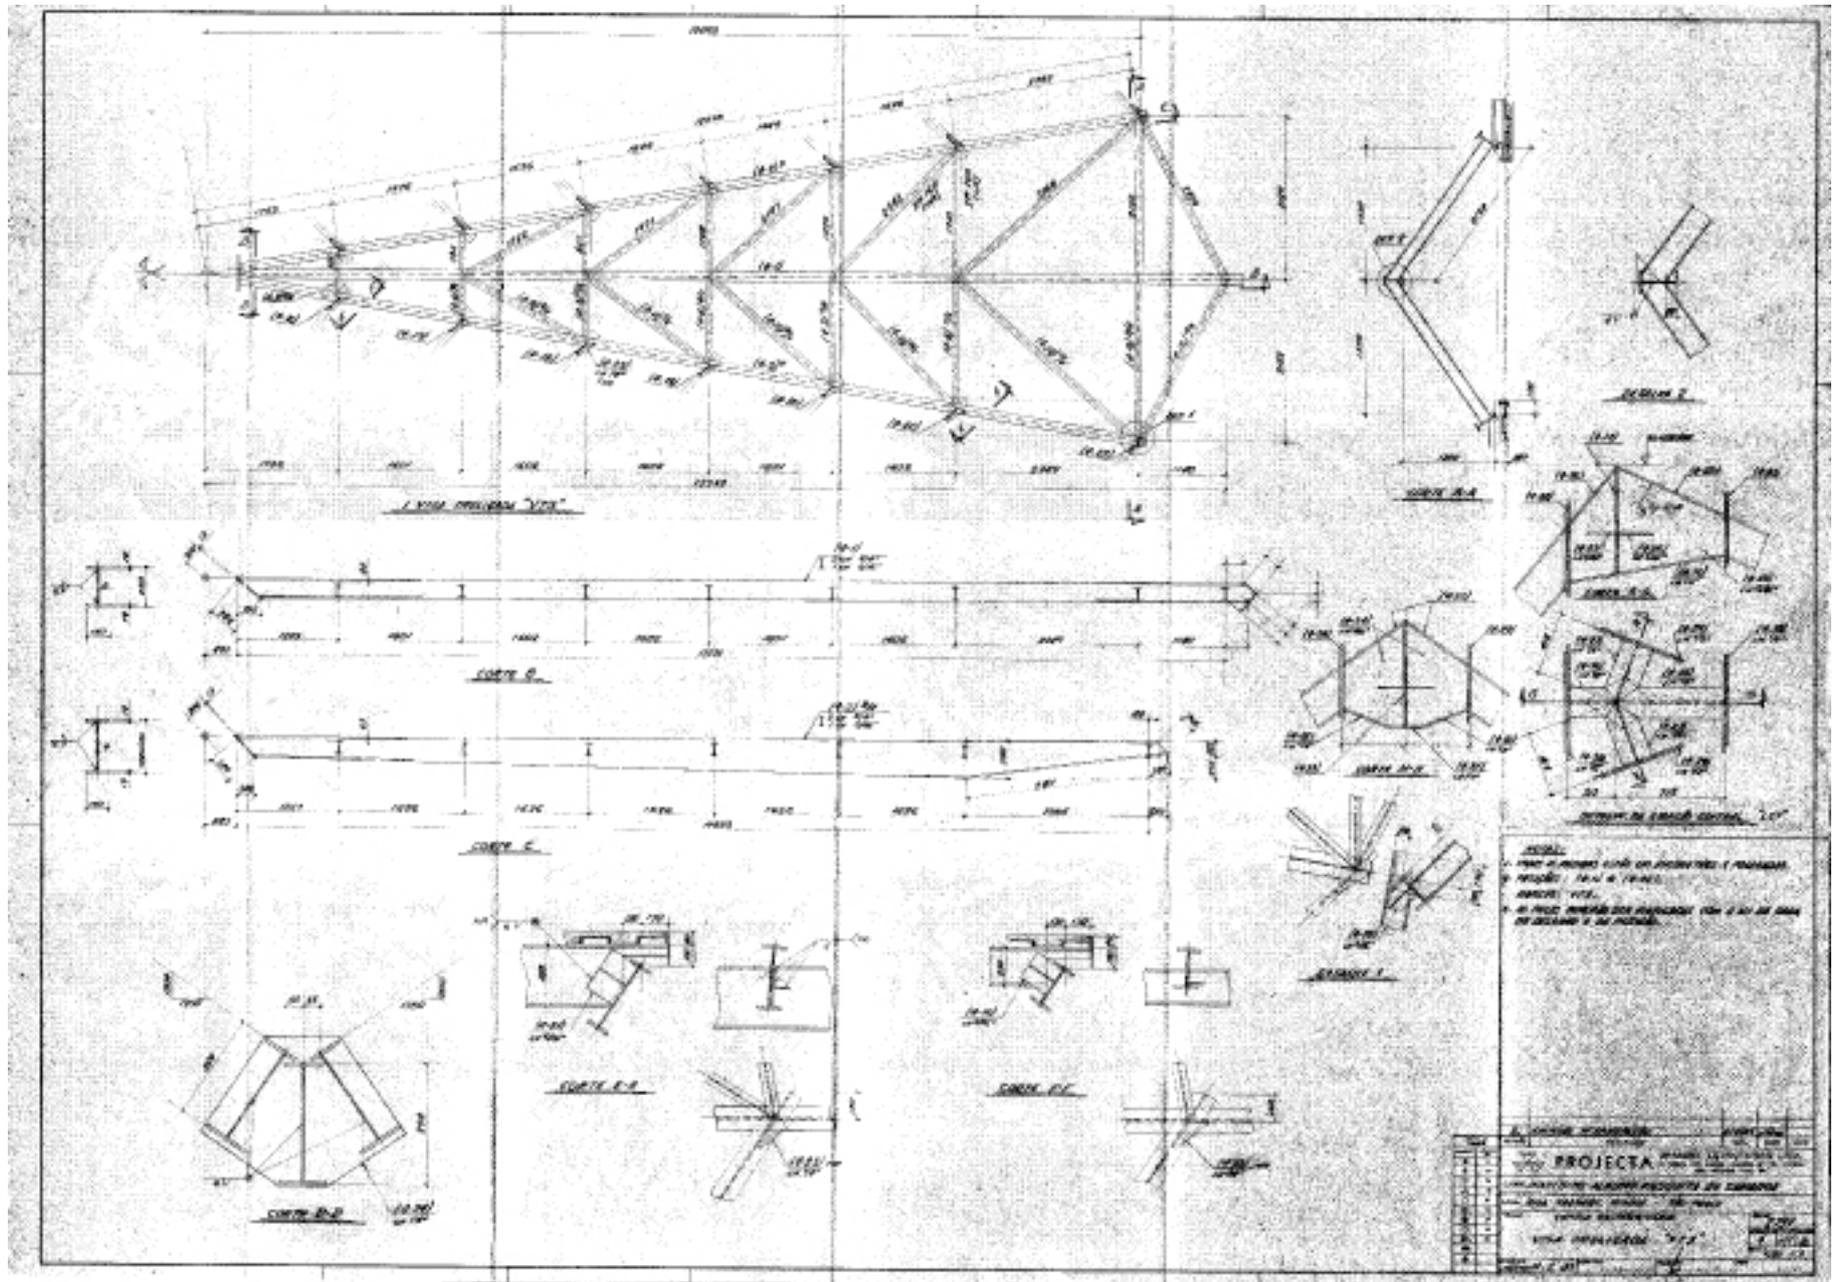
c – Projeto executivo realizado pela empresa Projeta (11/02/1985). Detalhamento da viga treliçada VT3. Fonte: arquivo do escritório Shieh Arquitetos Associados.
